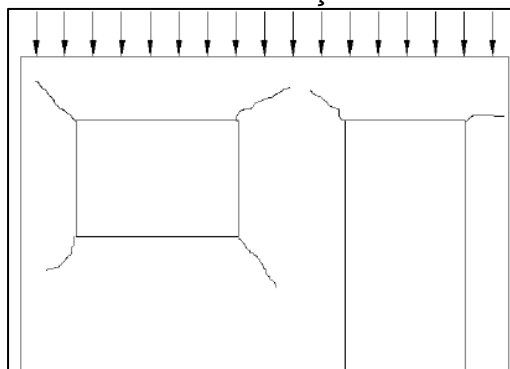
Fissuras de sobrecargas devido a blocos inadequados
